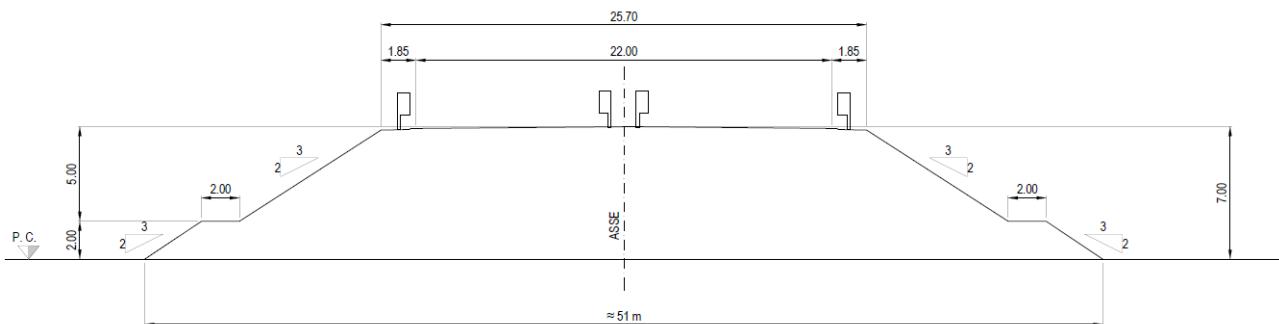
Sezione Tipo A rilevato autostradale H = 7.0 m
